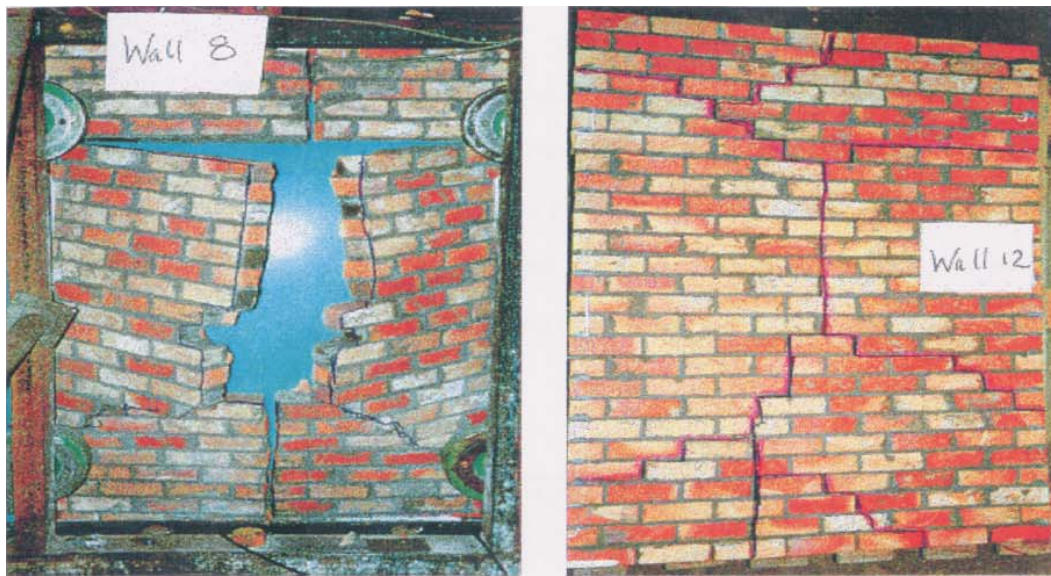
Ensaio experimental das paredes Wall 8 e Wall 12. Retirado de [15]
